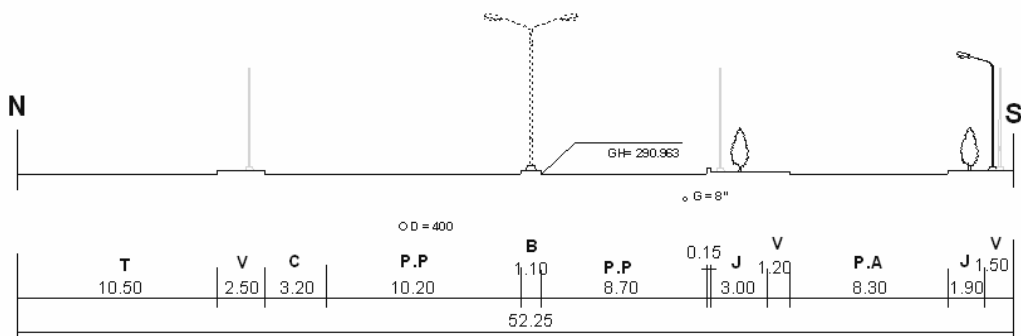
Sección Transversal Típica de la Av. Ayllón y Carretera Central Existente
